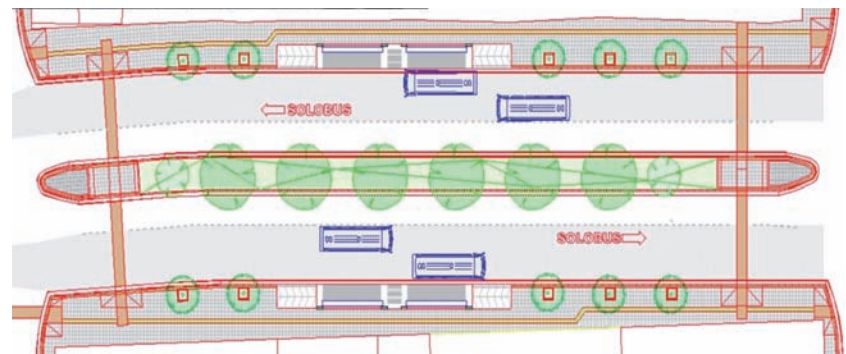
//Perfil propuesto Cra 27. Fuente: Plan de Movilidad de Pasto (POT)//
